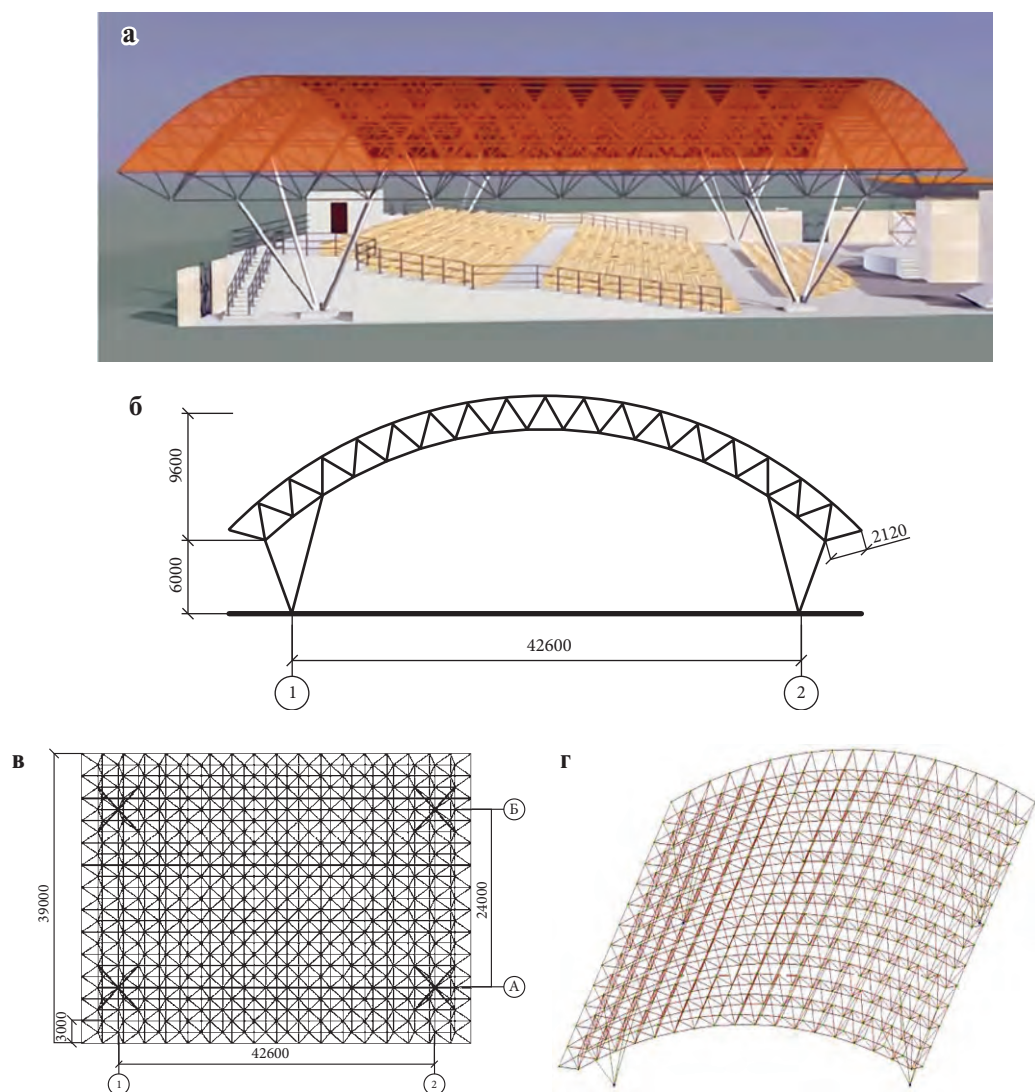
Пример структурной цилиндрической оболочки покрытия (сводчатой): а) общий вид; б) поперечный разрез покрытия; в) план покрытия; г) пространственная конечно-элементная расчетная схема
